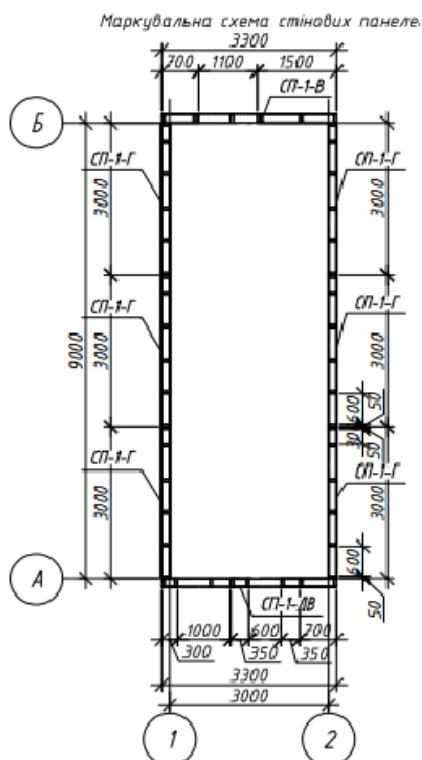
Маркувальна схема стінових панелей на плані модульної будівлі
